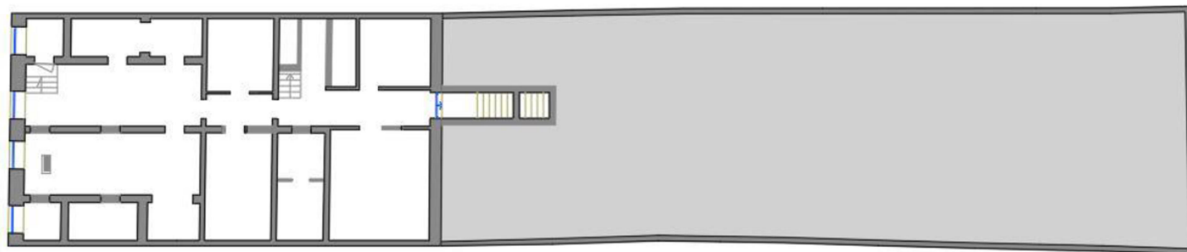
Planta de arquitetura original da cave (sem escala)
